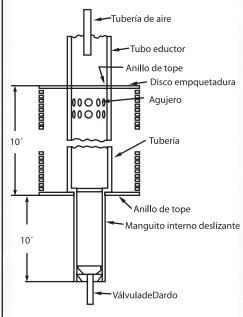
Una herramienta combinada como esta de la figura, diseñada por Geotechnica, permite que la arena sea bombeada del pozo sin tener que sacar previamente la herramienta de chorros
